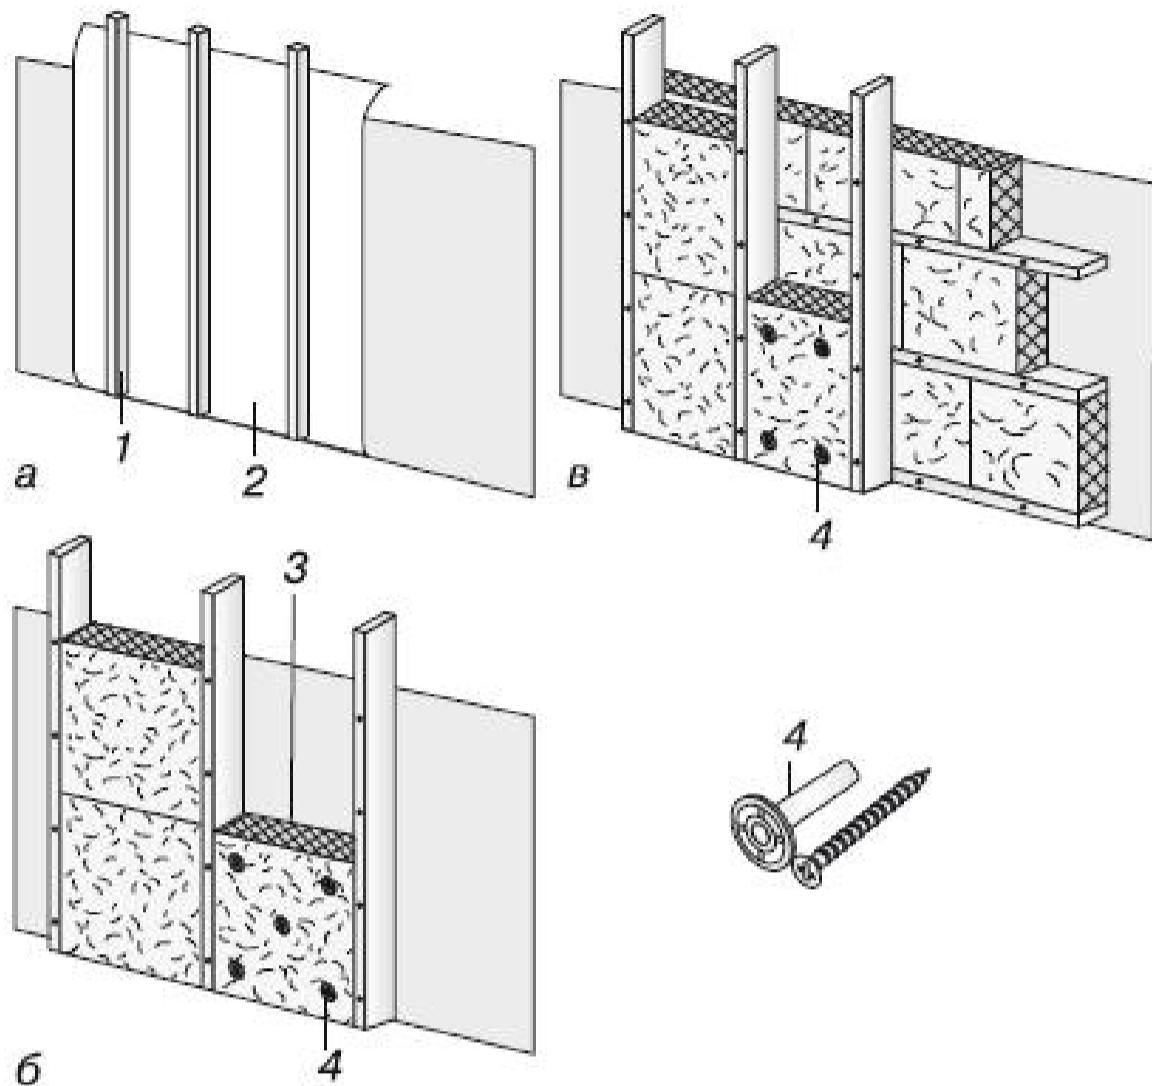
Утепление стен: а – рулонным утеплителем; б – межкаркасное в один слой; в – межкаркасное в два слоя; 1 – обрешетка; 2 – рулонный утеплитель; 3 – плитный утеплитель; 4 – «грибок»
